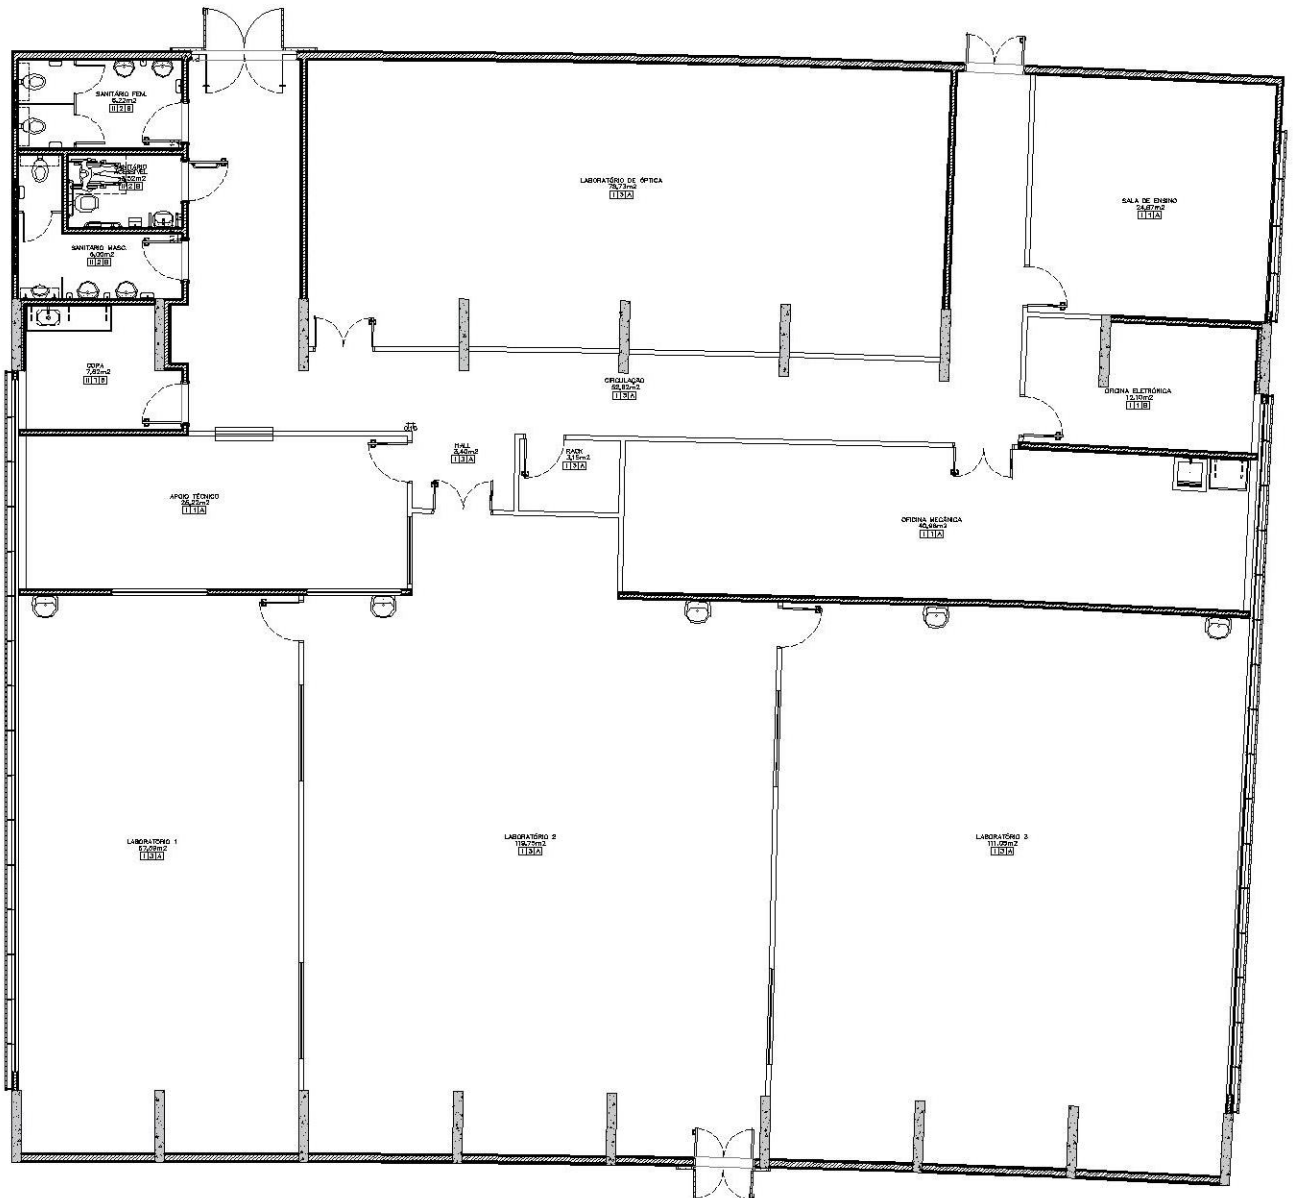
Planta Baixa mostrando distribuição dos ambientes.
